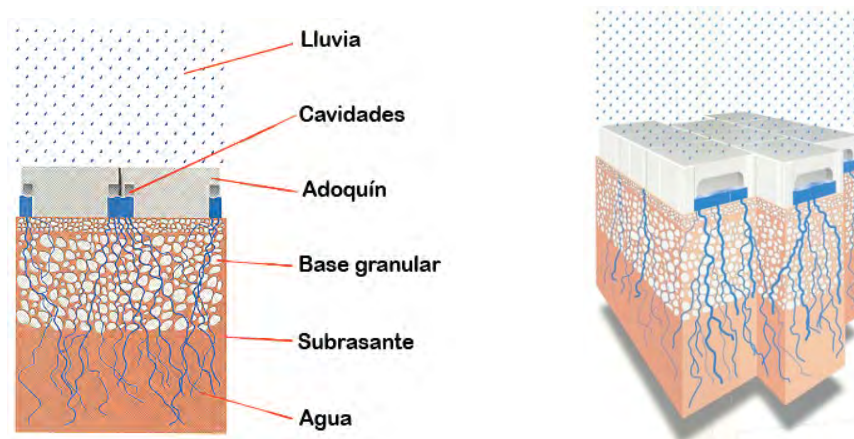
PAVIMENTOS PERMEABLES DE ADOQUÍN DE CONCRETO
